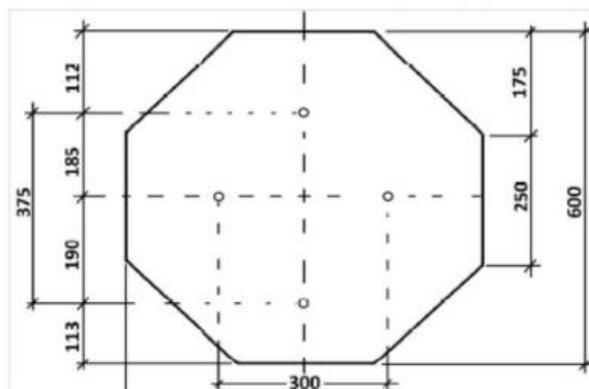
Detalhe do Dispositivo Anti-Giro e da Fundação
